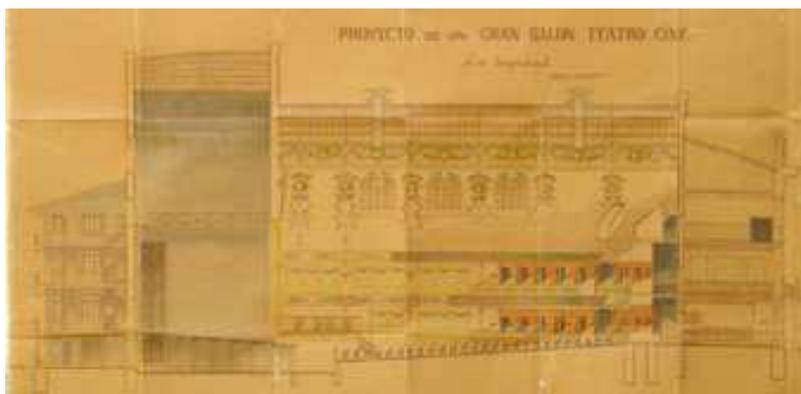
Plano corte longitudinal. (COFFINO, A., *Proyecto de 1913*)
